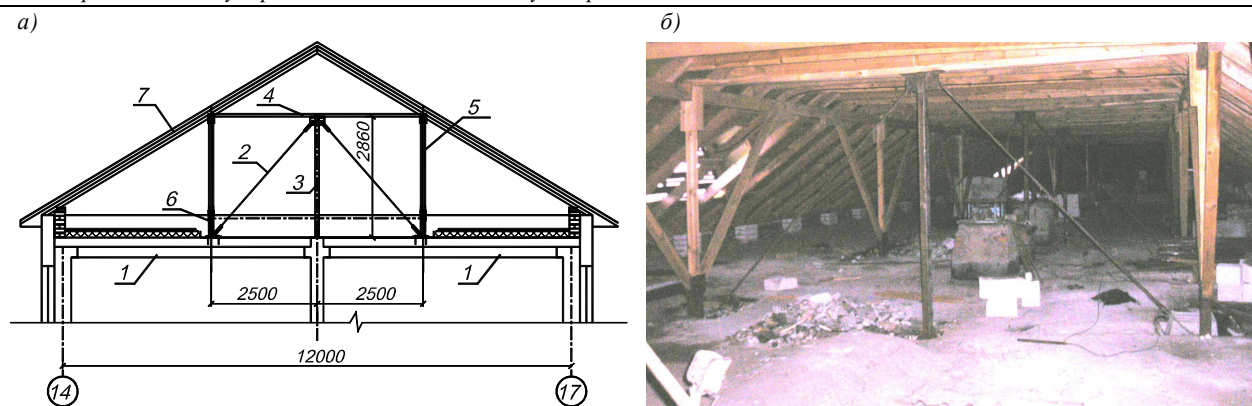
Схема разгрузки ригеля перекрытия включением его в БВС
